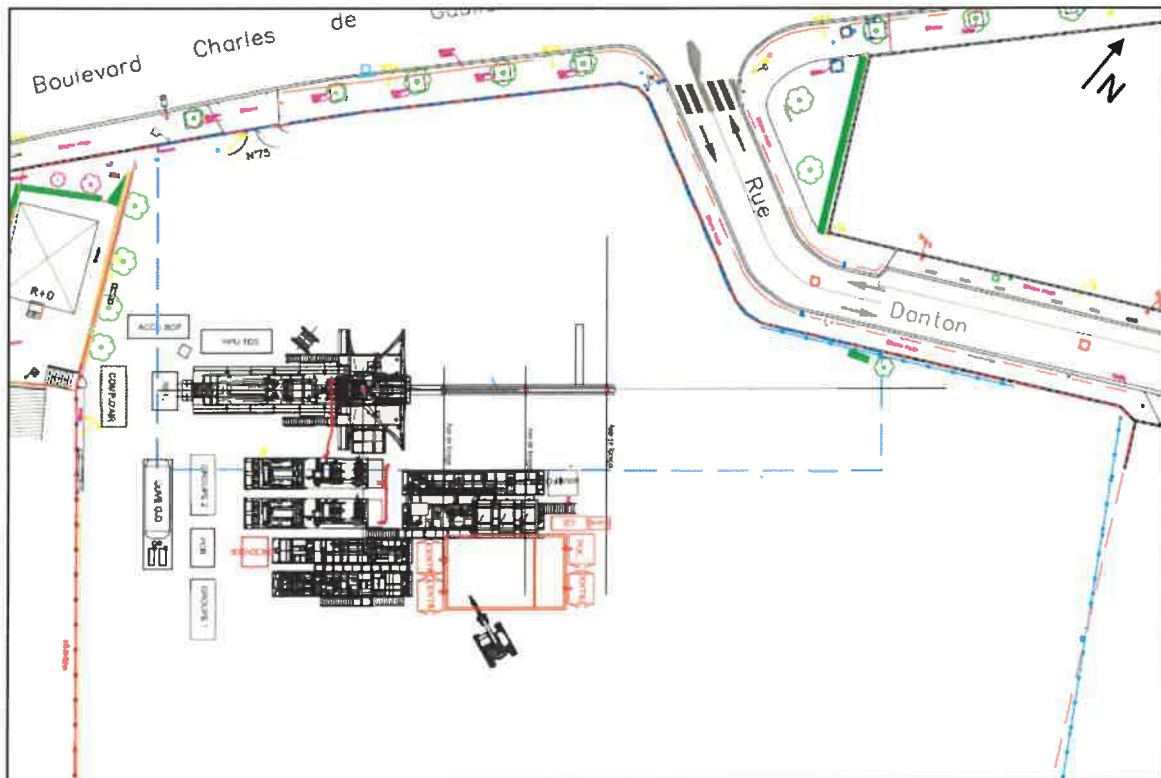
Exemple d'implantation sur la plateforme d'un appareil de forage de type pétrolier (source : Entrepouse Drilling)
